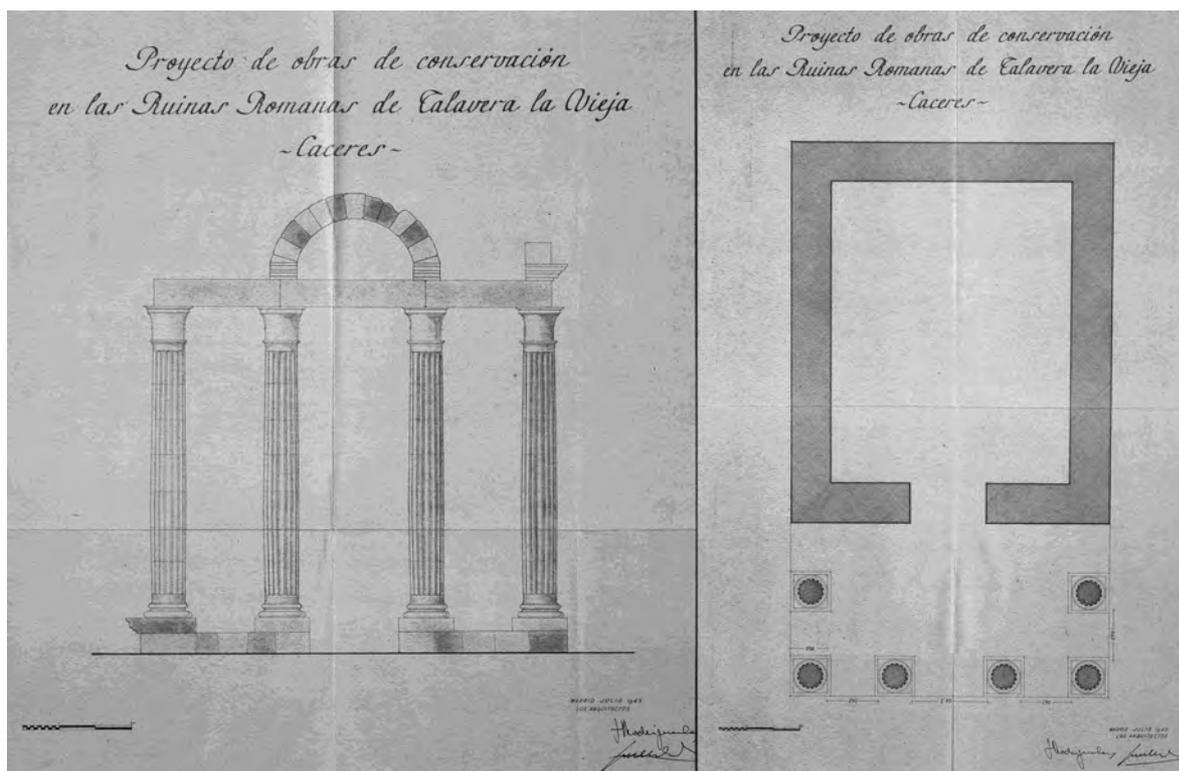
Planta y alzado del edificio de “los mármoles” en el proyecto de conservación redactado en 1949. Ministerio de Cultura, Instituto de Patrimonio Cultural de España.
